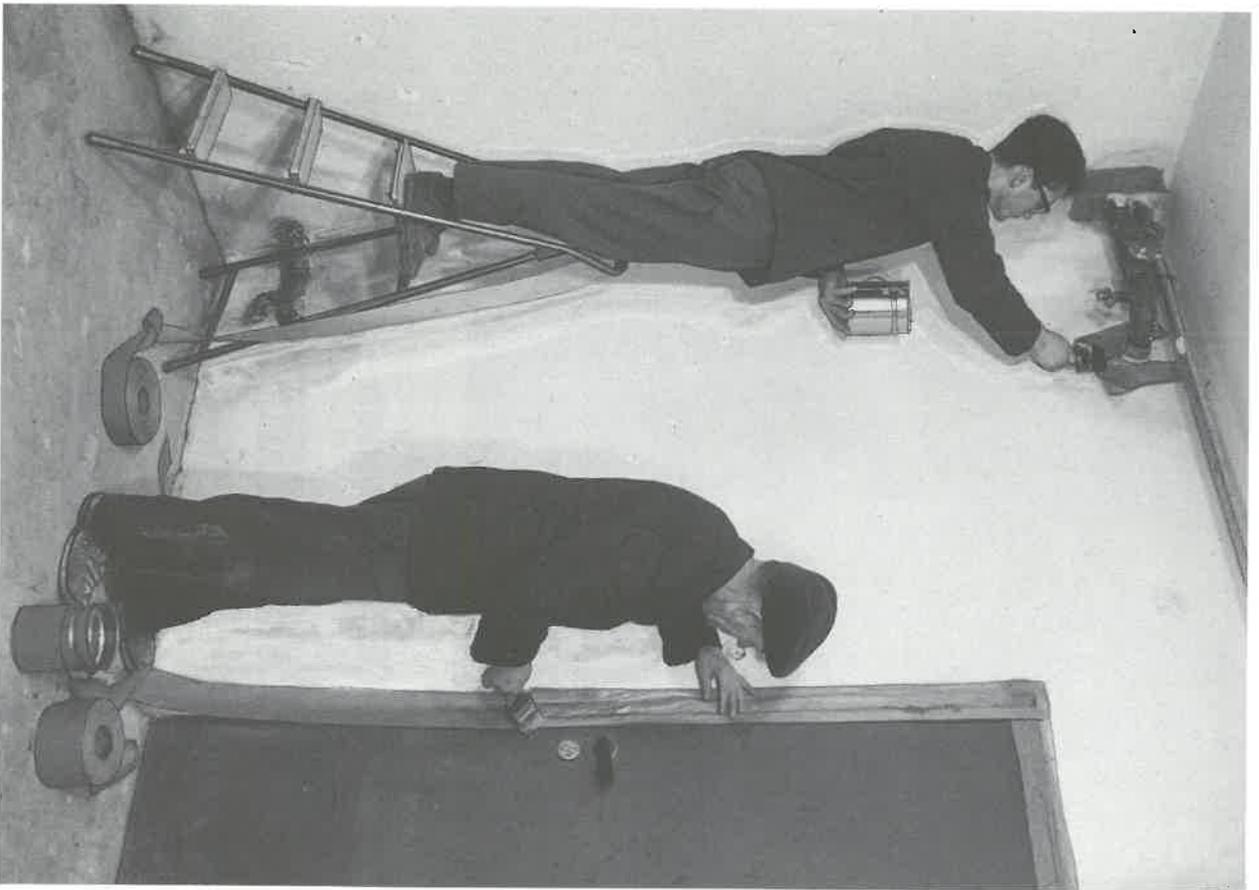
Vor jeder Begassung werden Risse und Fugen im Mauerwerk mit Spezialpapier abgeklebt
